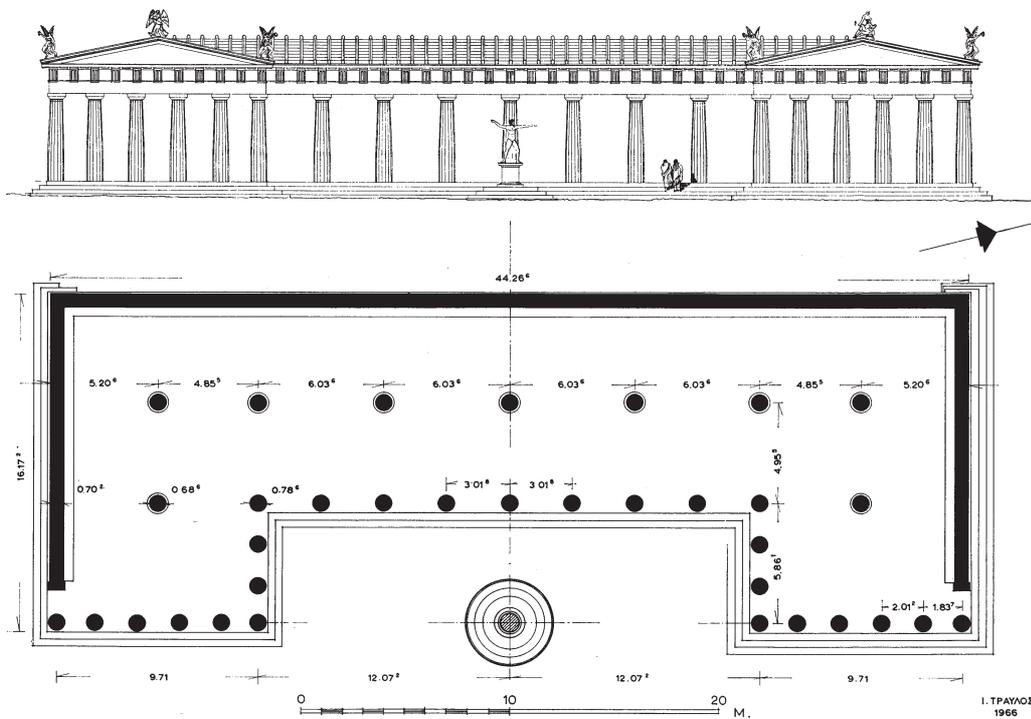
Athen, Zeusstoa: Rekonstruktion von Aufriss und Grundriss. – (Nach Travlos 1971, 529 Abb. 666).
